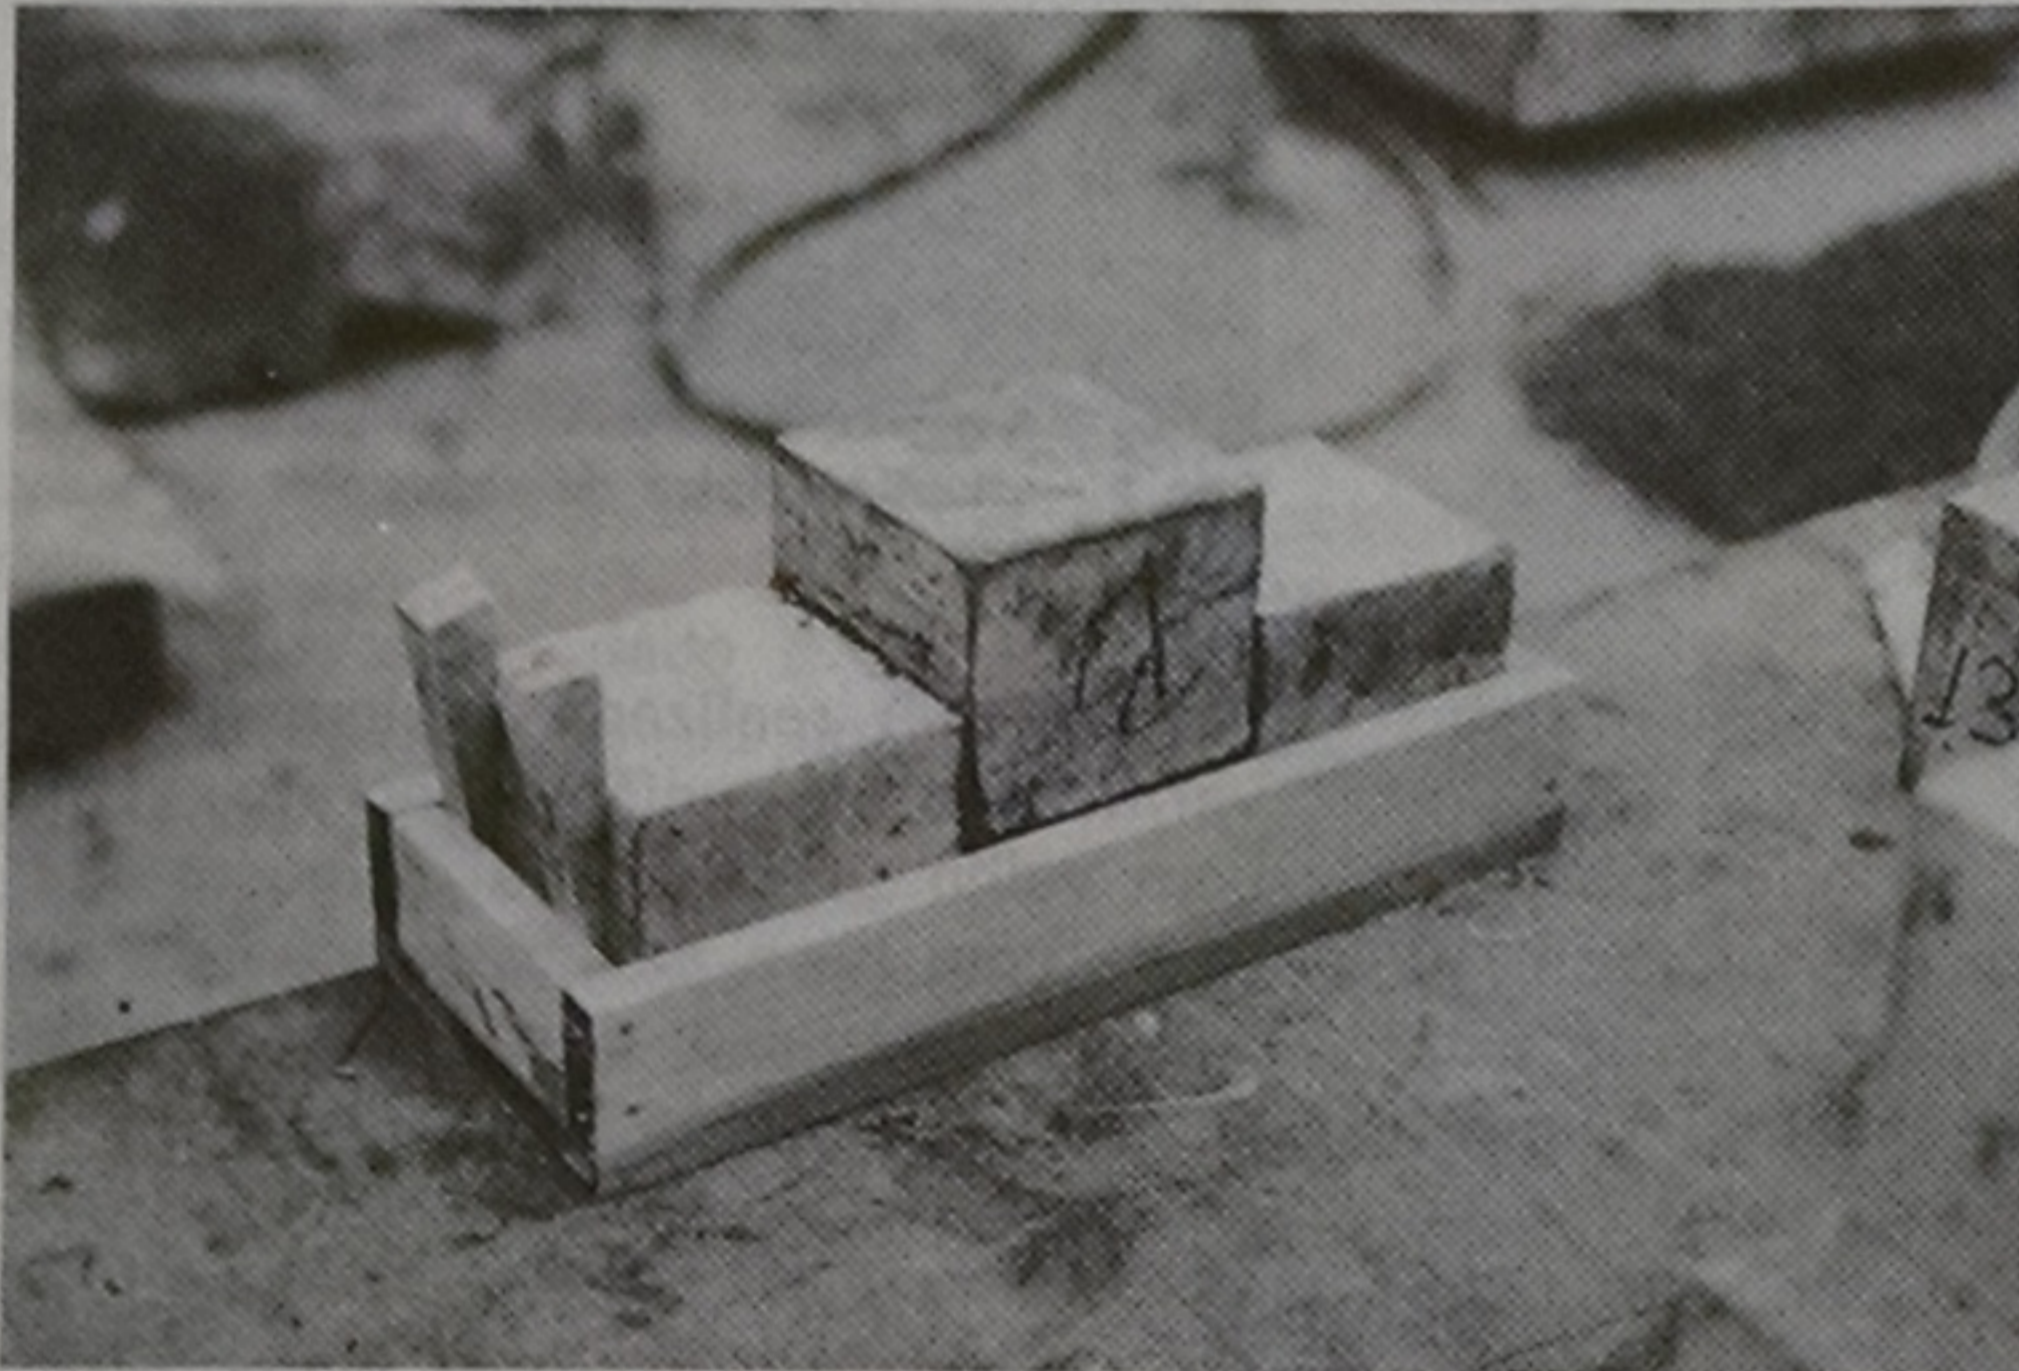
Moldagem dos corpos de prova destinados ao ensaio de cisalhamento
